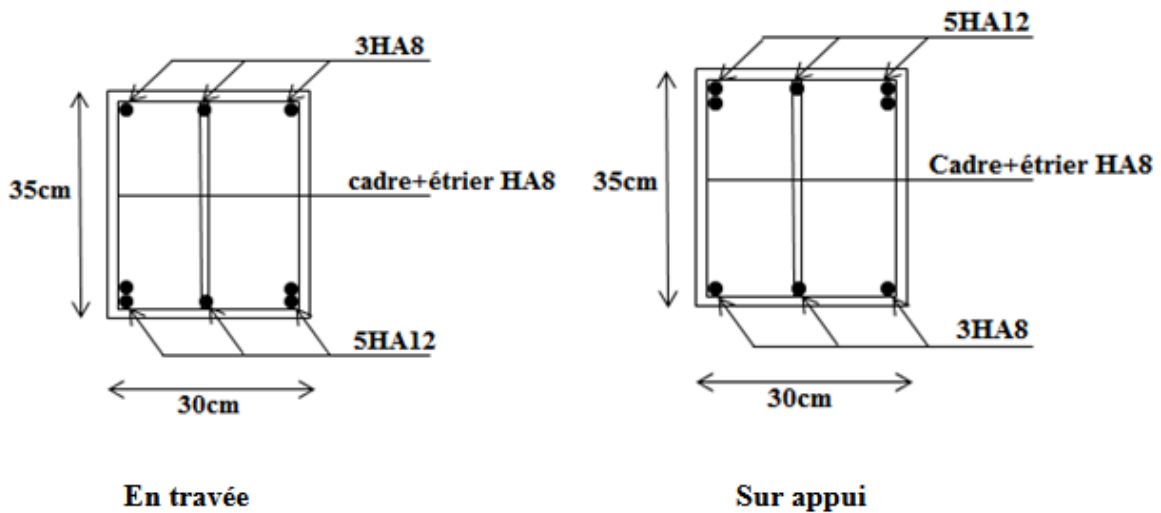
Ferraillage de la poutre palière sur appui et en travée
